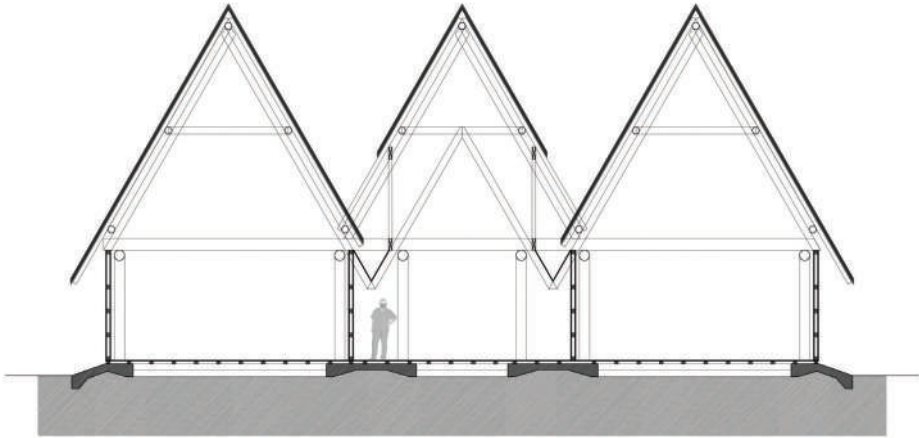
Corte esquemático preliminar de sistema estructural. Elaboración: Equipo proyectista, 2013
